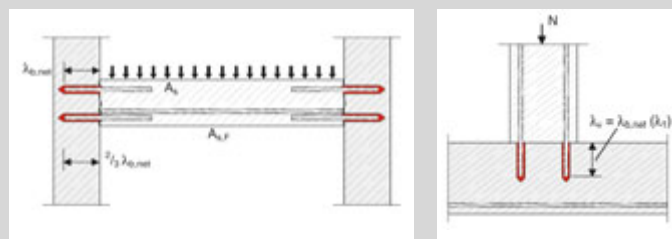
Anclaje de las armaduras de vigas y losas simplemente apoyadas en la zona de apoyos.
